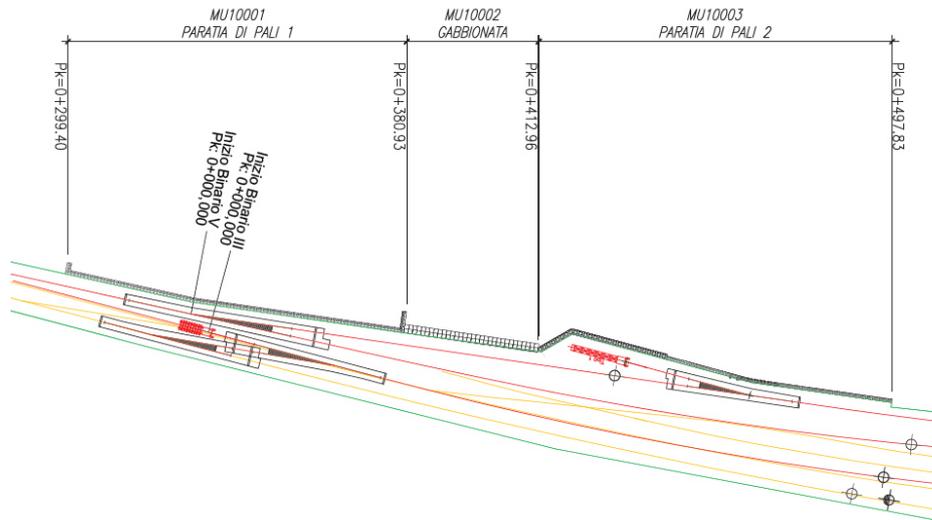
Opere di sostegno - Stralcio planimetrico 1
